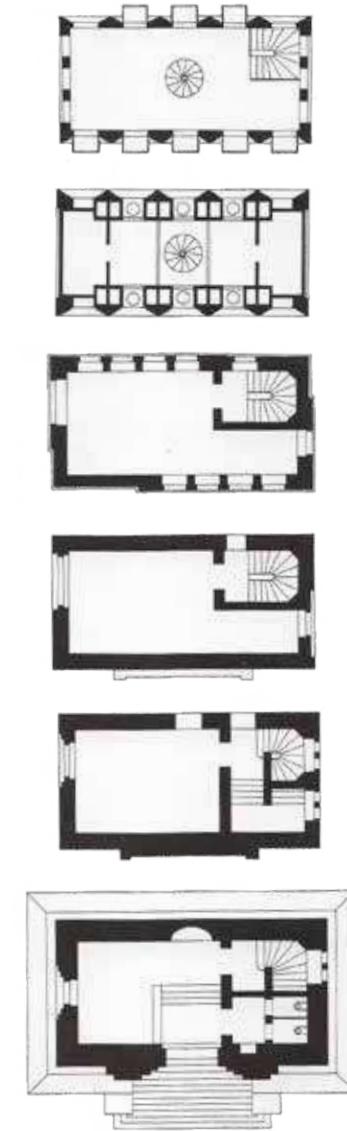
Hochzeitsturm, Grundrisse, 1908
